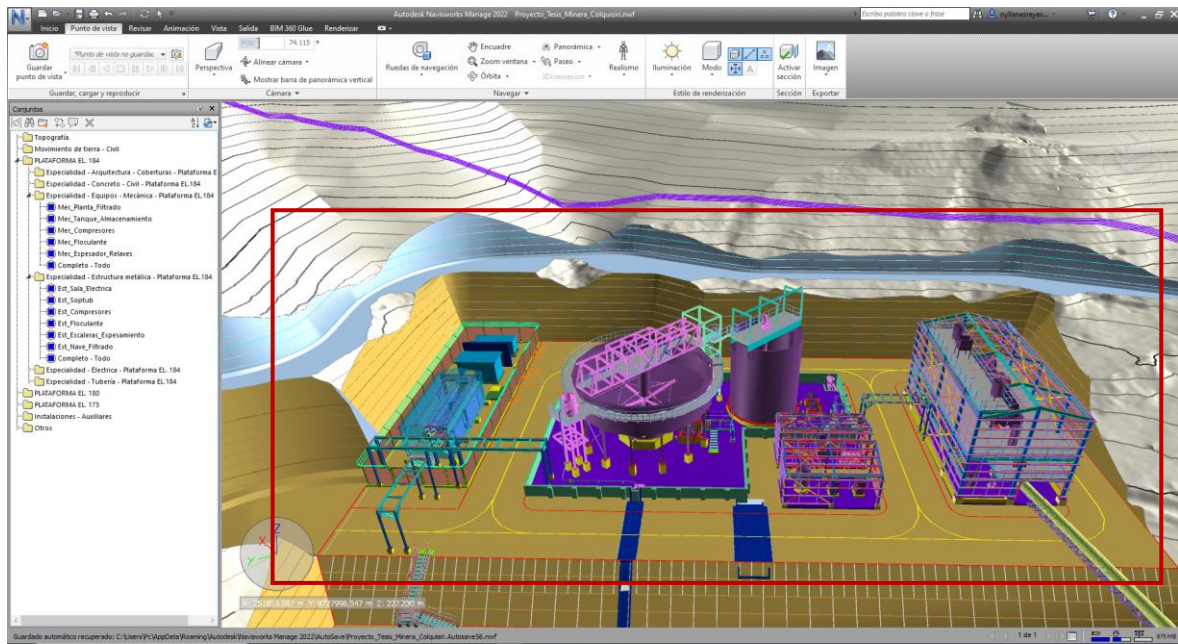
Importación de los modelos de estructura metálica y mecánica en planta.
